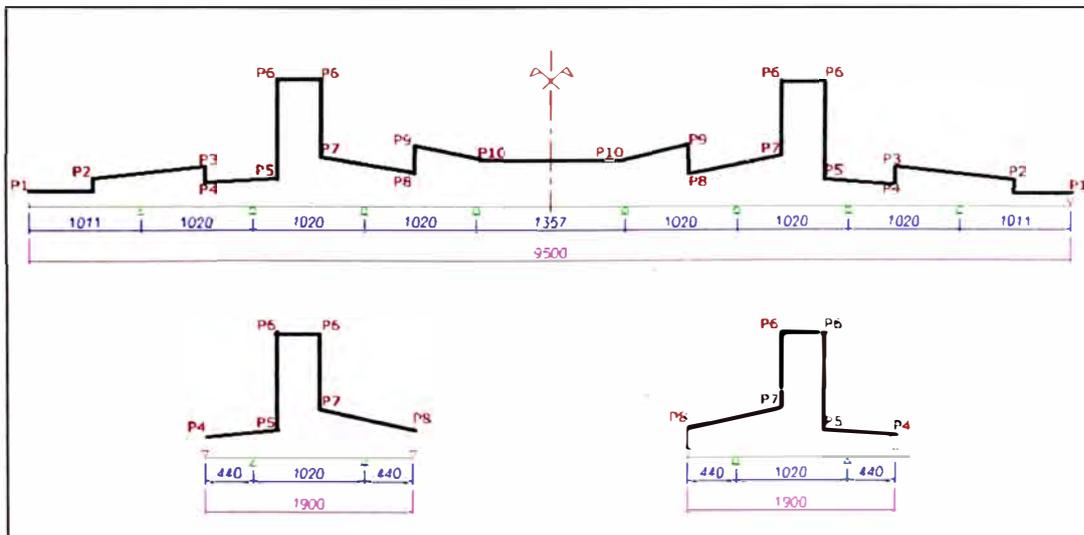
Esquema de cargas sobre vigas VM20 (mm).
